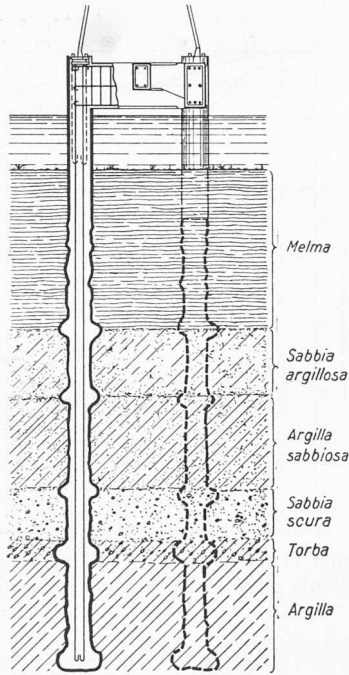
Pfahlfundierung für die Masten Bild 15. Interessant sind im Bodenprofil die heute tiefliegenden Torfschichten. 1:200
